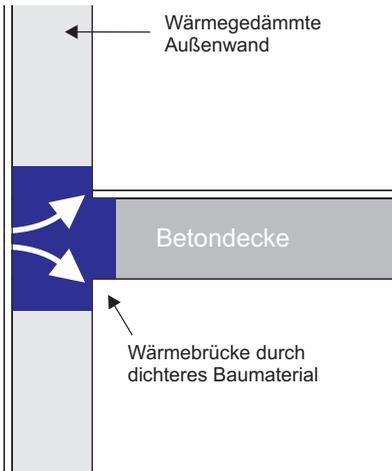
An tragenden Bauteilen mit geringer Materialdichte und damit guter Wärmeleitung (z.B. Beton) ergeben sich Wärmebrücken, die Kondenswasserbildung begünstigen.
